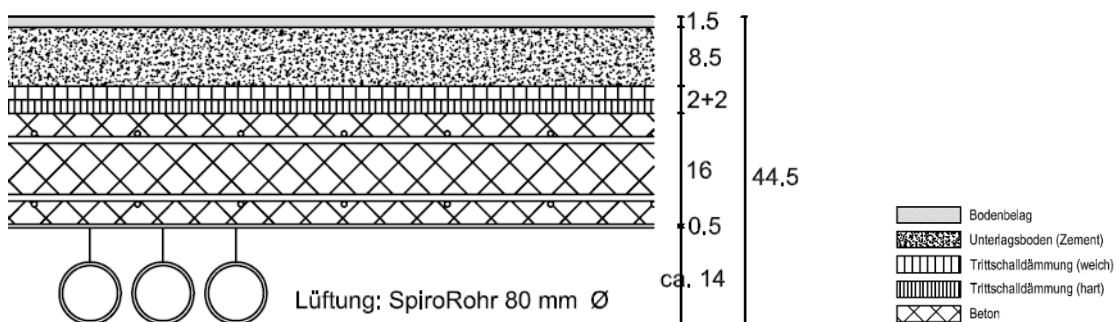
Querschnitt Zusatzvariante 4b «Leitungen sichtbar geführt, Betondecke nach Statik dimensioniert (16 cm)» mit 85 mm Zement-Unterlagsboden
